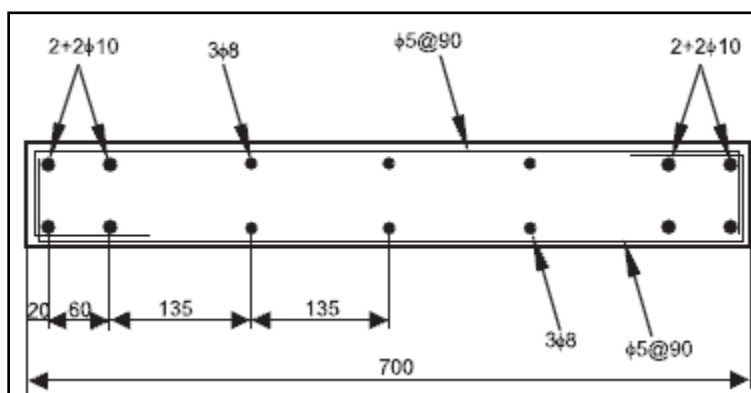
Detalles del armado del muro W1 (dimensiones en mm) (desde Alarcón et al. [35]).
